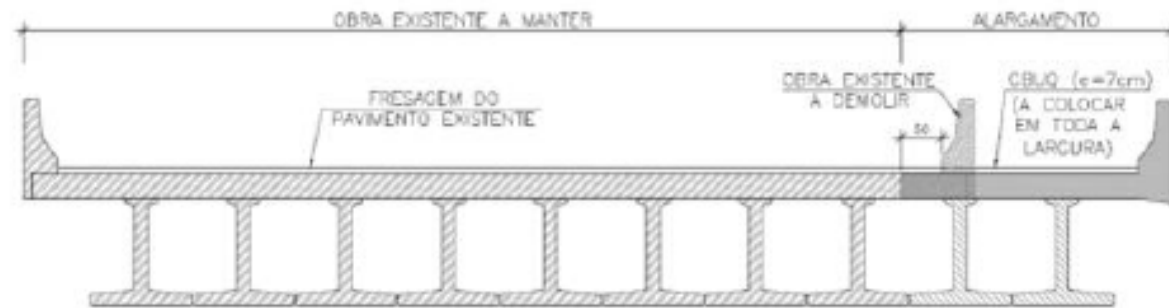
Seção Transversal Típica em Obras de Alargamento – Tipo D
